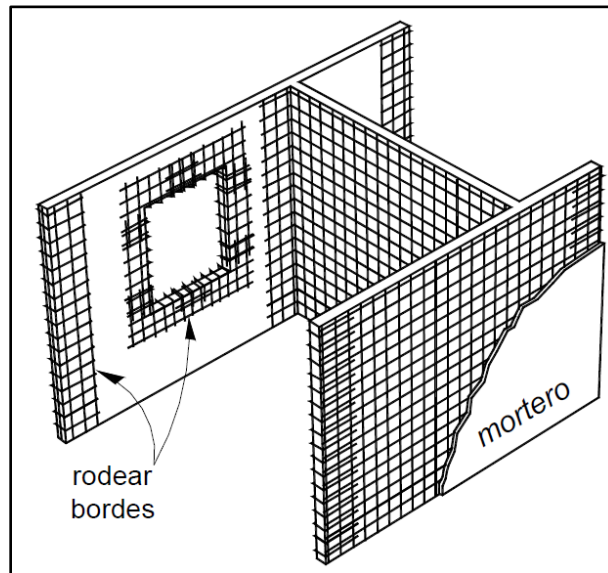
Refuerzo de muros con malla electro-soldada
